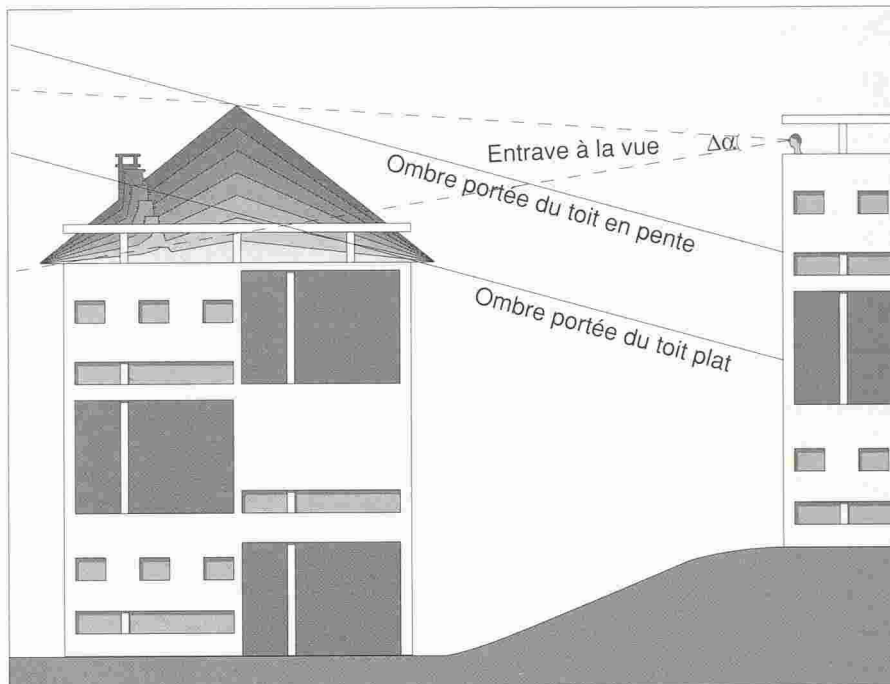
Remplacement d'un toit plat par un toit en pente lors d'une réfection: entrave à l'ensoleillement et à la vue.
